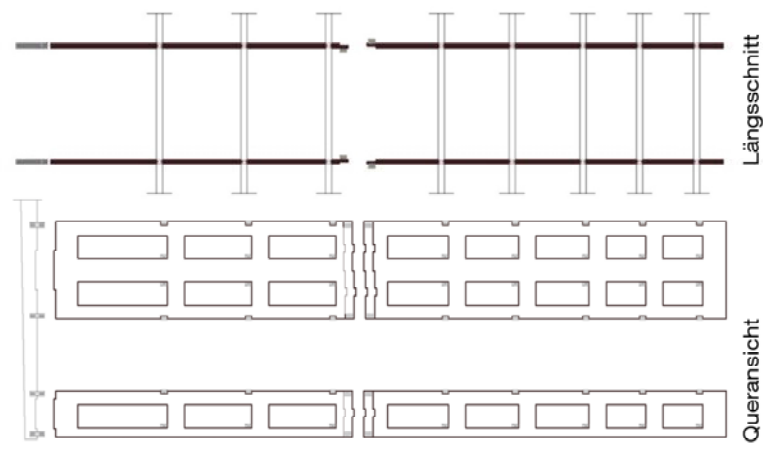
Darstellung des Grundrisses, der Längs- und Lagerquerrichtung eines beispielhaften Hochregallagers
